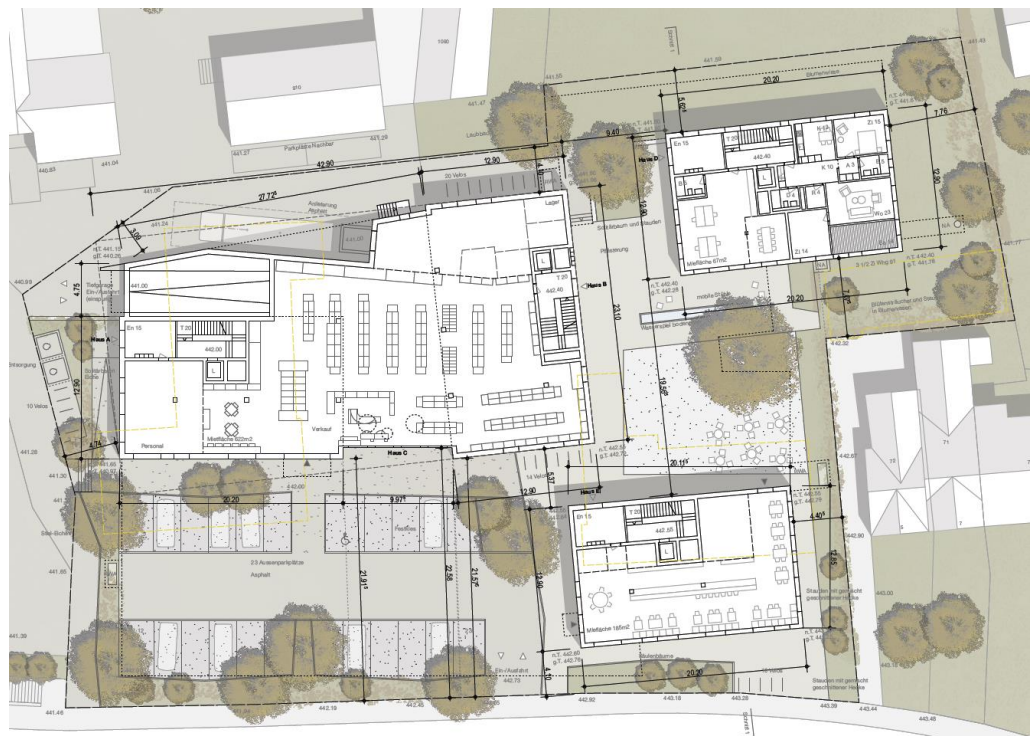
Situation Erdgeschoss der Überbauung an der Sulgerstrasse. Nicht massstäblich. Plan: VIOLA ARCHITEKTEN, Juli 2022.
